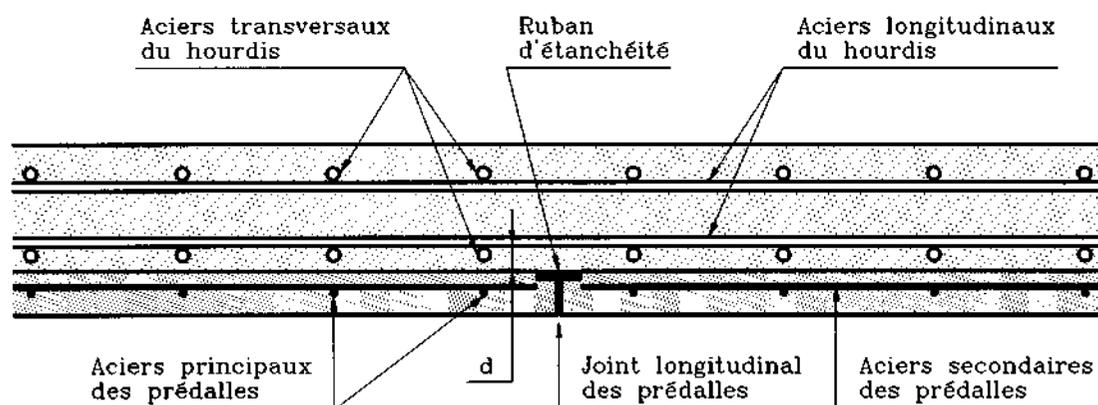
Non-continuité des armatures longitudinales des prédalles
